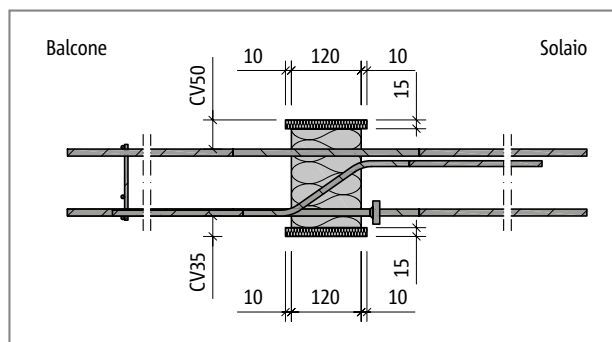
Schöck Isokorb® tipo EXT30-CV50, REI120: sezione dell'elemento
